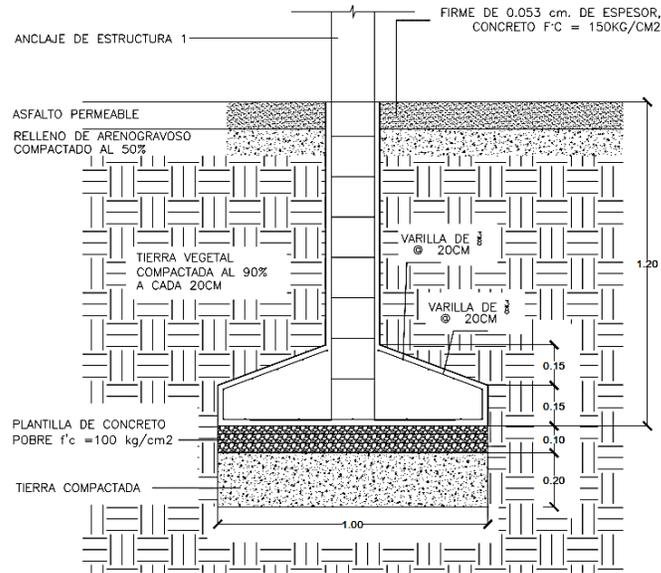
Zapata aislada para estructuras ornamentales, (Elaboración propia, 2021)
